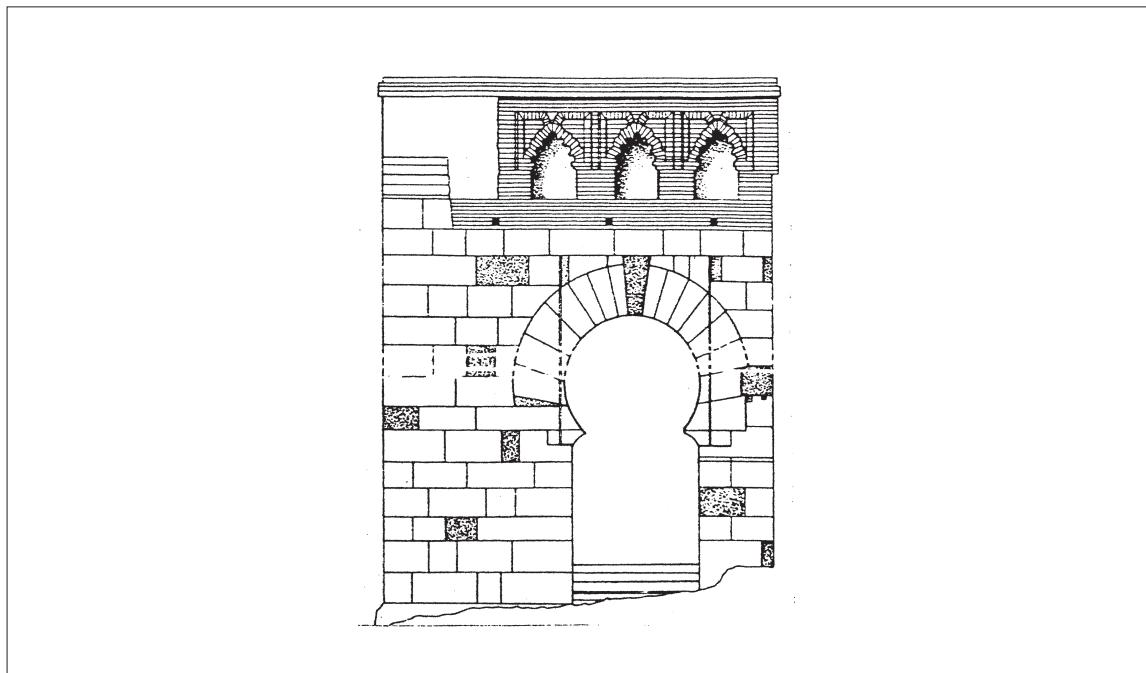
لبلة. باب المرقأ، مسقط أفقى. عن (Maldonado).
